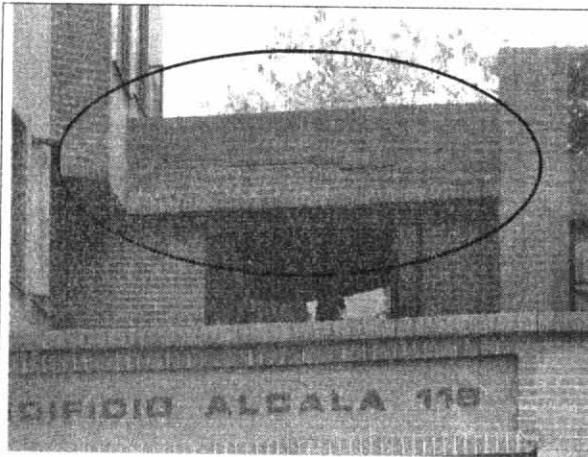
Agrietamiento en muro fachada de la estructura adosada.
